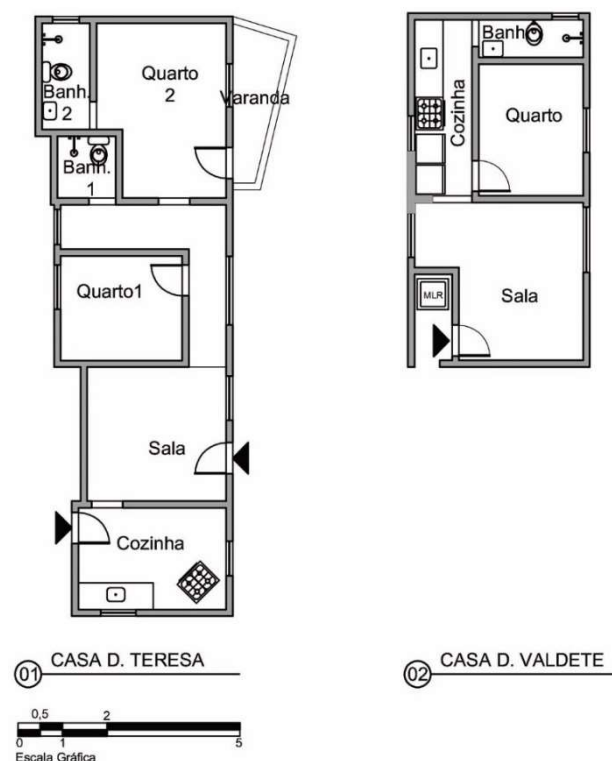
plantas casa de esquina. fonte: acervo da autora.
